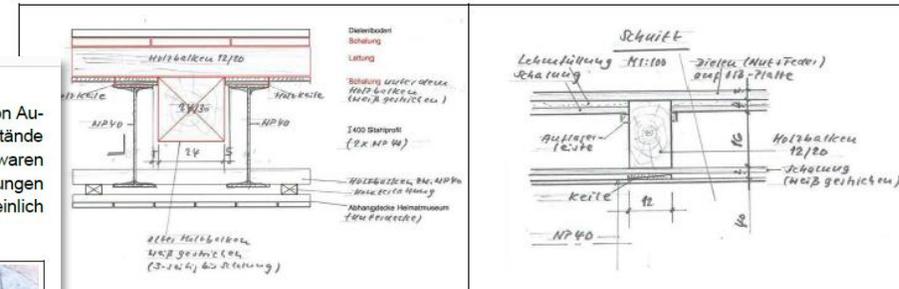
Deckenaufbau - Stahlträger (Ö6) Abb. 18: Deckenaufbau - Holz balken (Ö6)
